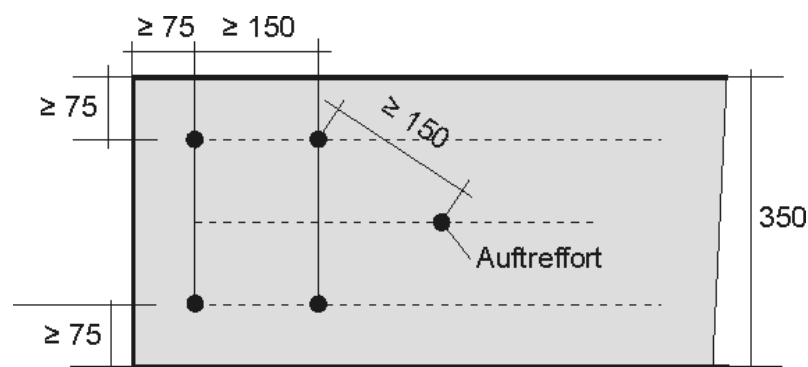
Beschussorte bei Dichtungsbahnen im Grundriss (Masse in Millimeter)
